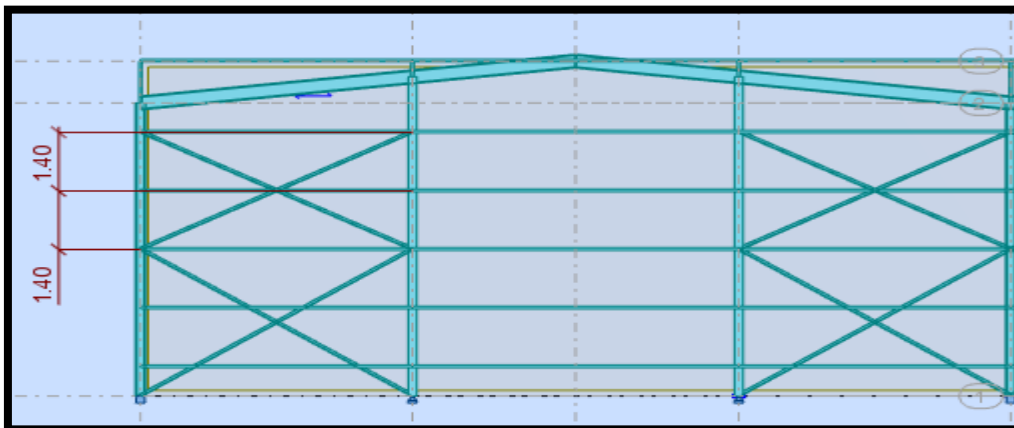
Coupe longitudinal sur les lisses de bardage.
